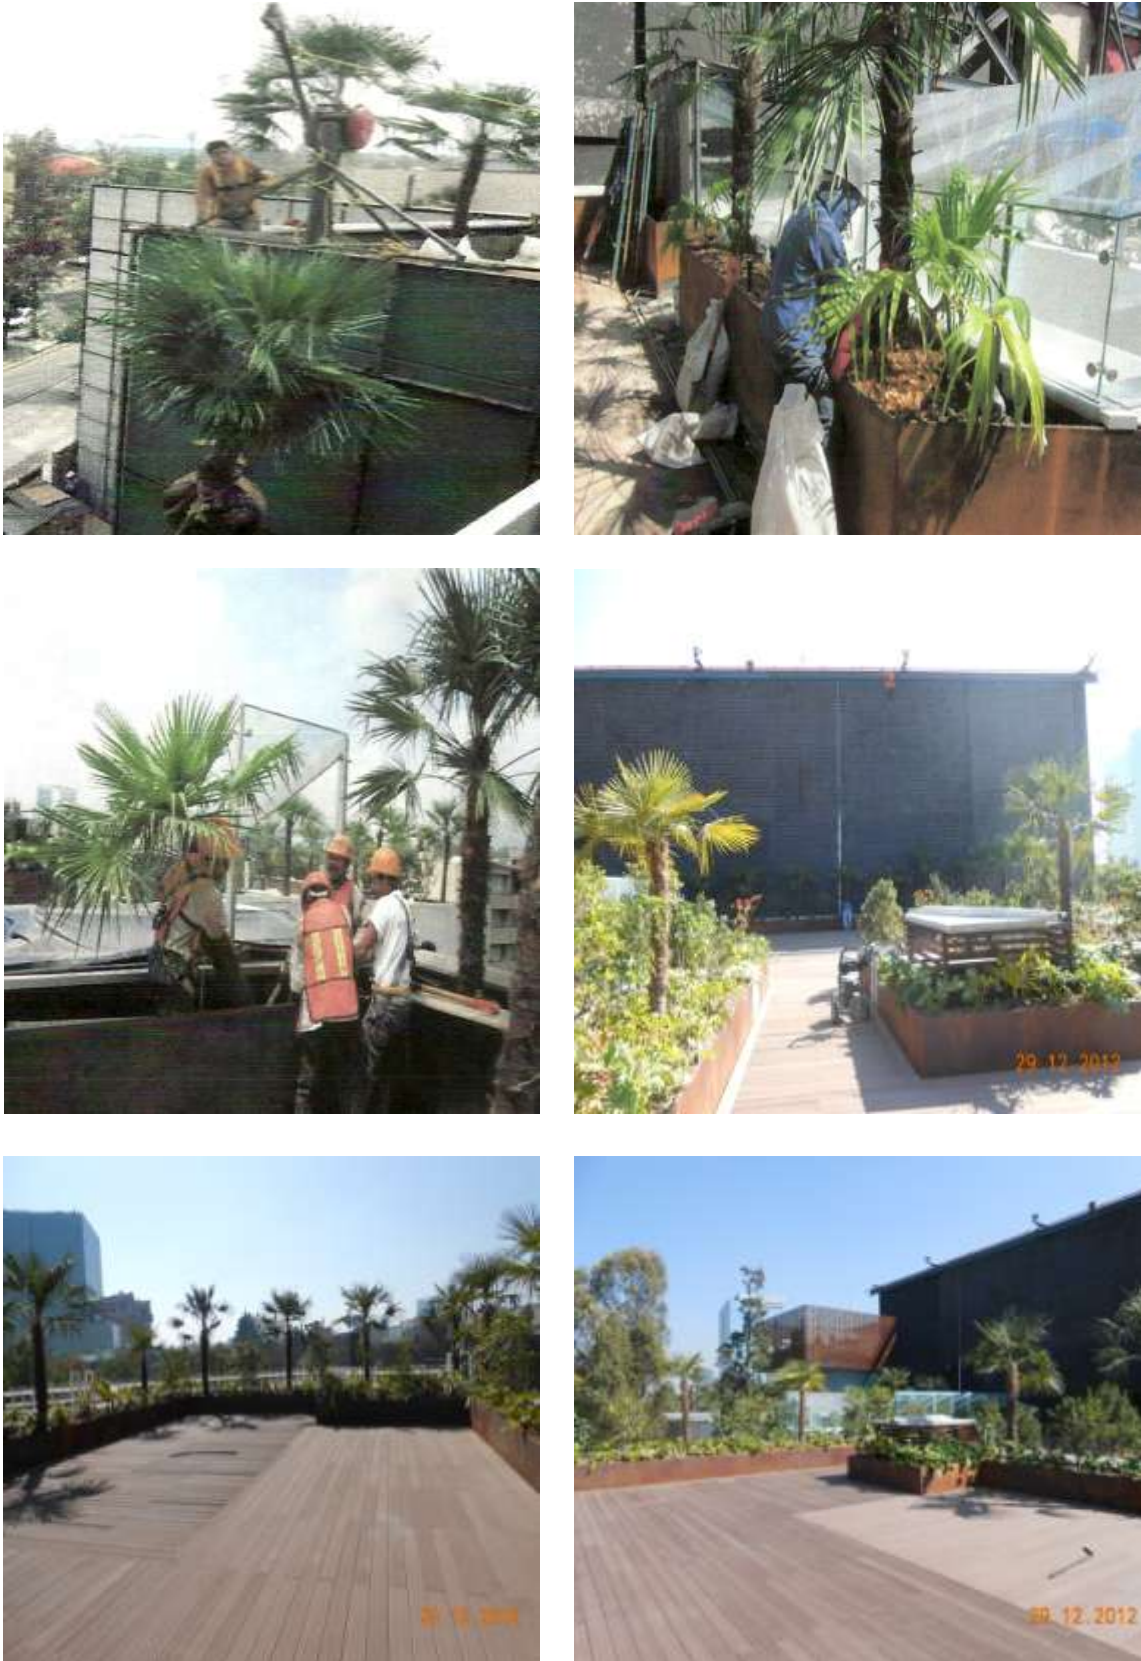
Procedimiento constructivo en Jardineras Horizontales en Roof Garden
